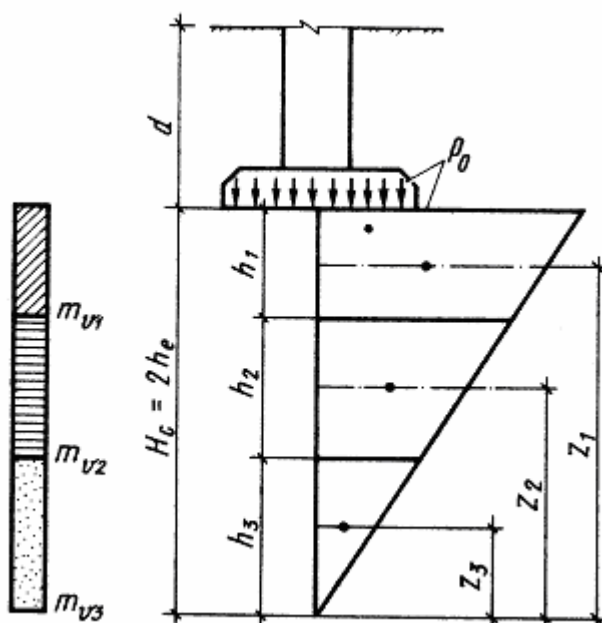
Расчетная схема к методу эквивалентного слоя при слоистом пластовании грунтов
